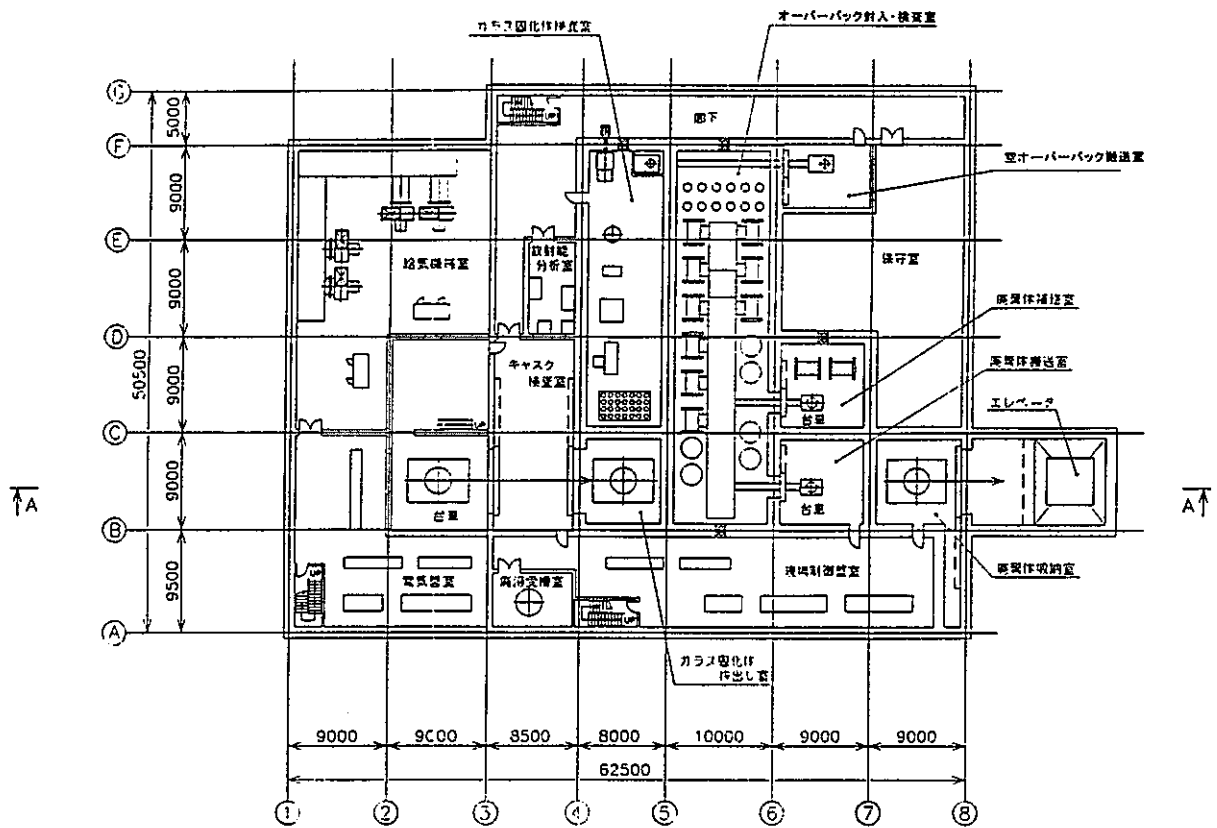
(1/4) 地上施設：廃棄物受け入れ・検査施設機器配置図（地下1階平面図）
